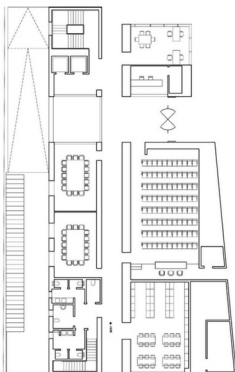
Plan przyziemia. Elewacja frontowa.
